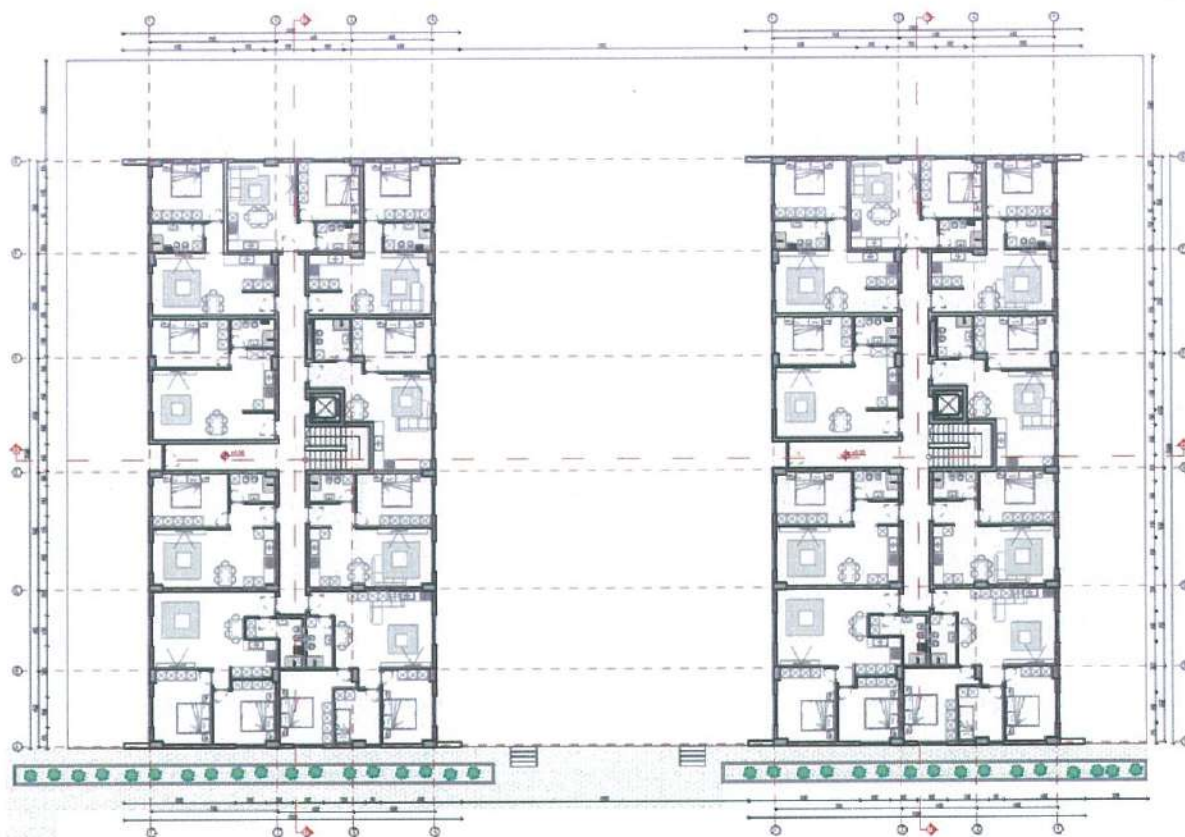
Planimetria e katit përdhe objekti 3 & 4
